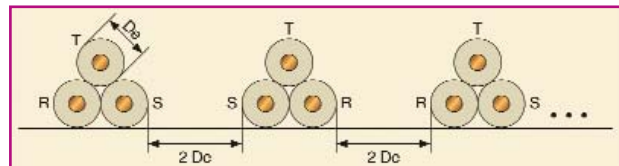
Disposição com os cabos de cada grupo RST posicionados em trifólio
